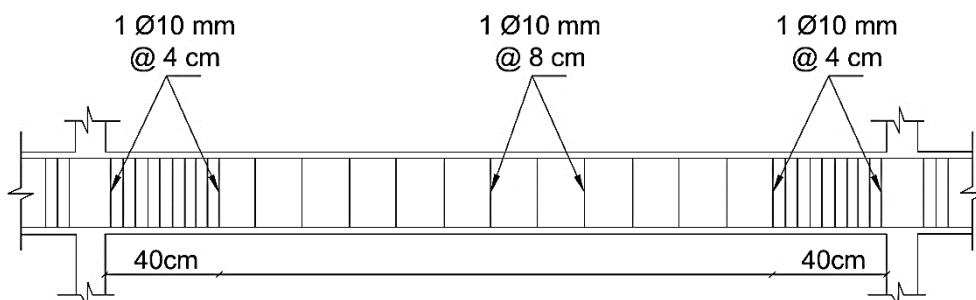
Separación de Estribos Viga – Diseño Sismorresistente.
